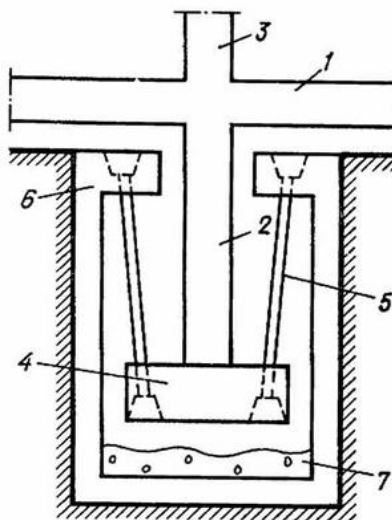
Сейсмоизолирующий фундамент с подвесными опорами:
